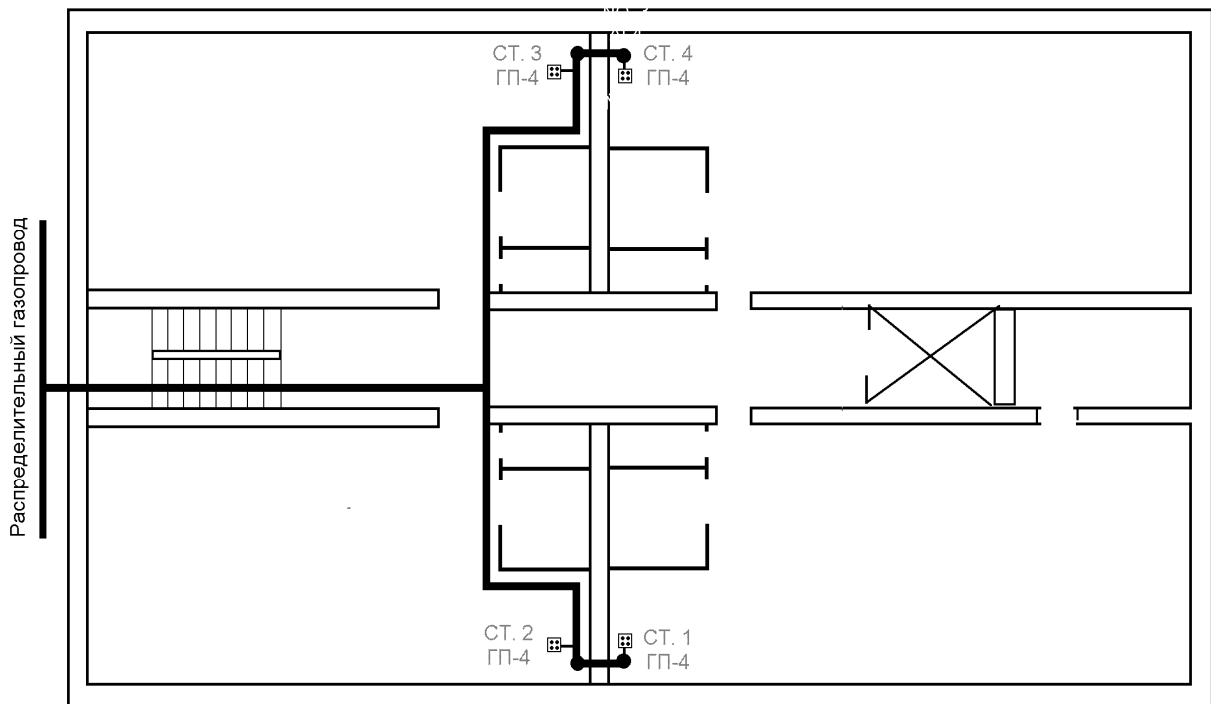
План типового этажа с расположением газопроводов и газовых приборов
